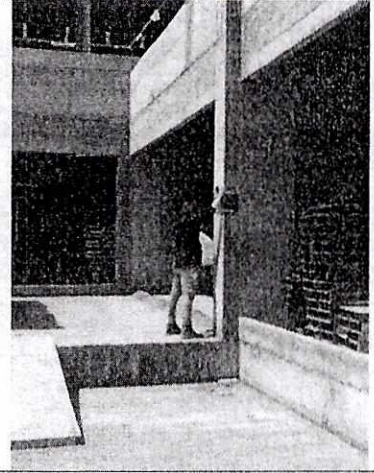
Colocación de sello de suspensión en el acceso frontal de la edificación.
